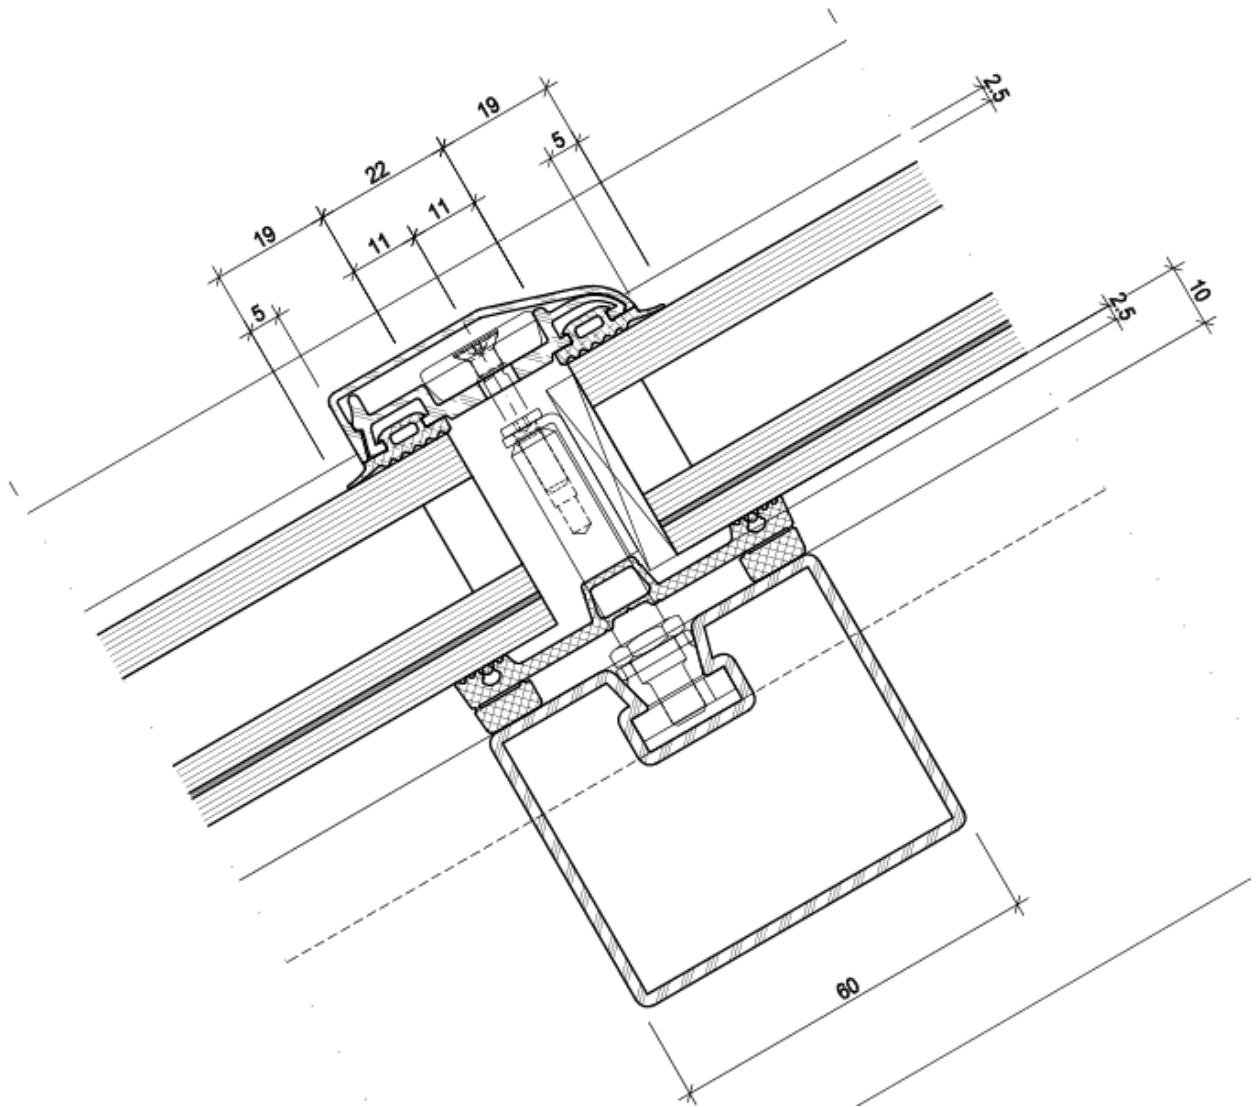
Prise en feuillure VISS façade verrière – 60 mm - Traverse
